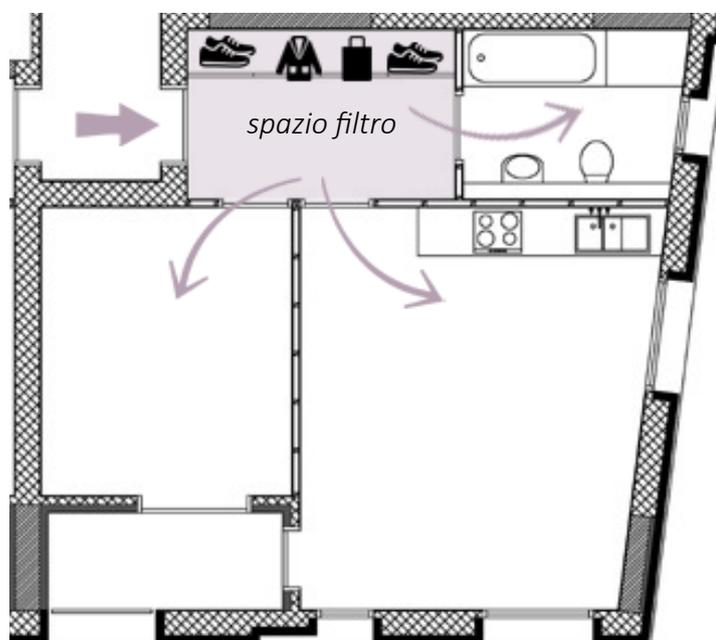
Rappresentazione planimetrica con individuazione ambiente ingresso-filtro.
